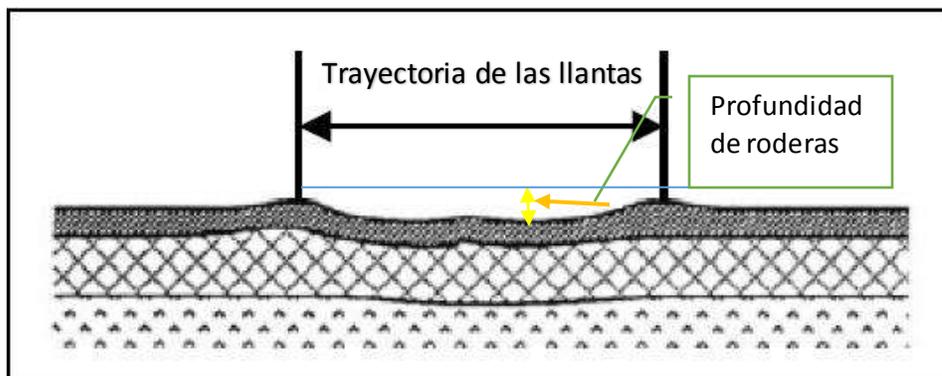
Roderas de un pavimento flexible apreciable por la regla en forma horizontal
